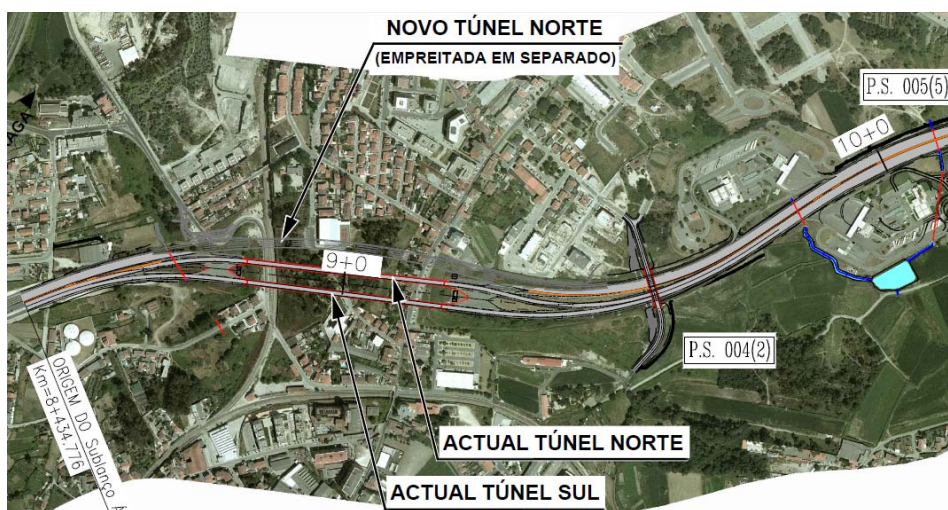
Planta de implantação prevista no projeto reformulado de 2015
